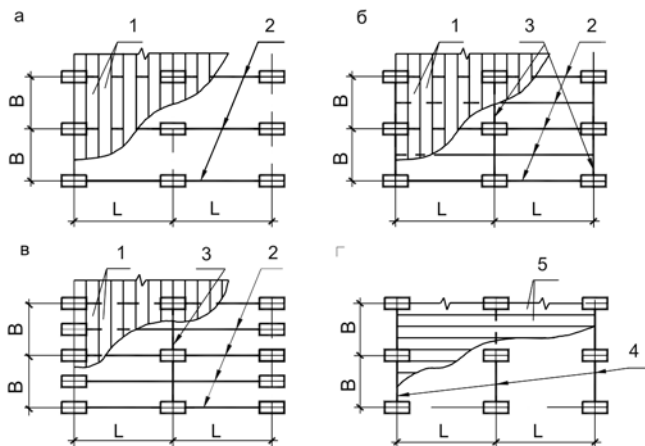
Варианты балочных схем покрытий: 1 - плиты покрытия; 2 - стропильные конструкции; 3 - подстропильные конструкции; 4 - продольные стропильные конструкции; 5 - крупноразмерные плиты покрытия “на пролет”
